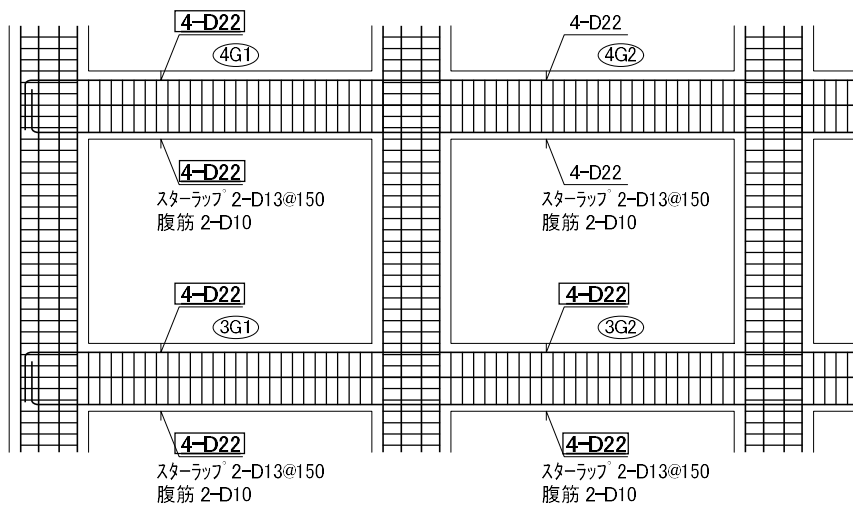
配筋詳細図 (内が大梁断面リストとの不整合箇所)
